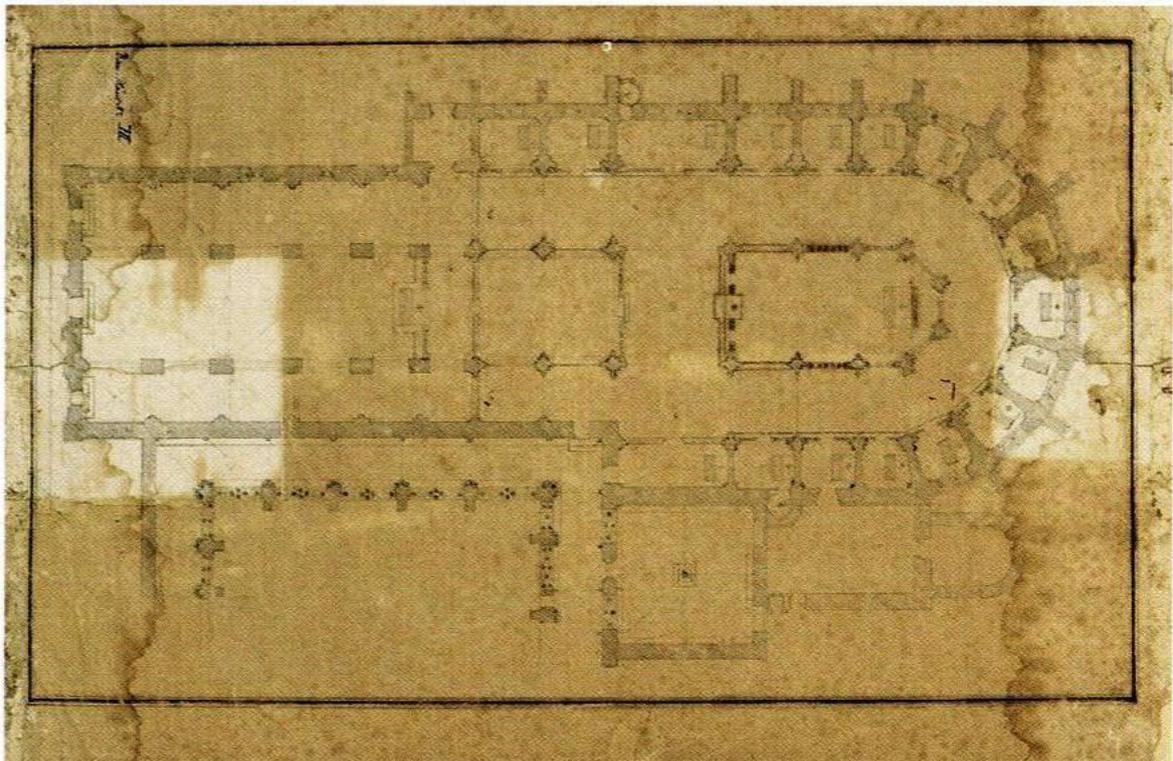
Stiftskirche Zwettl, Grundriss, vor 1722, StiAZ Plansammlung/III.
